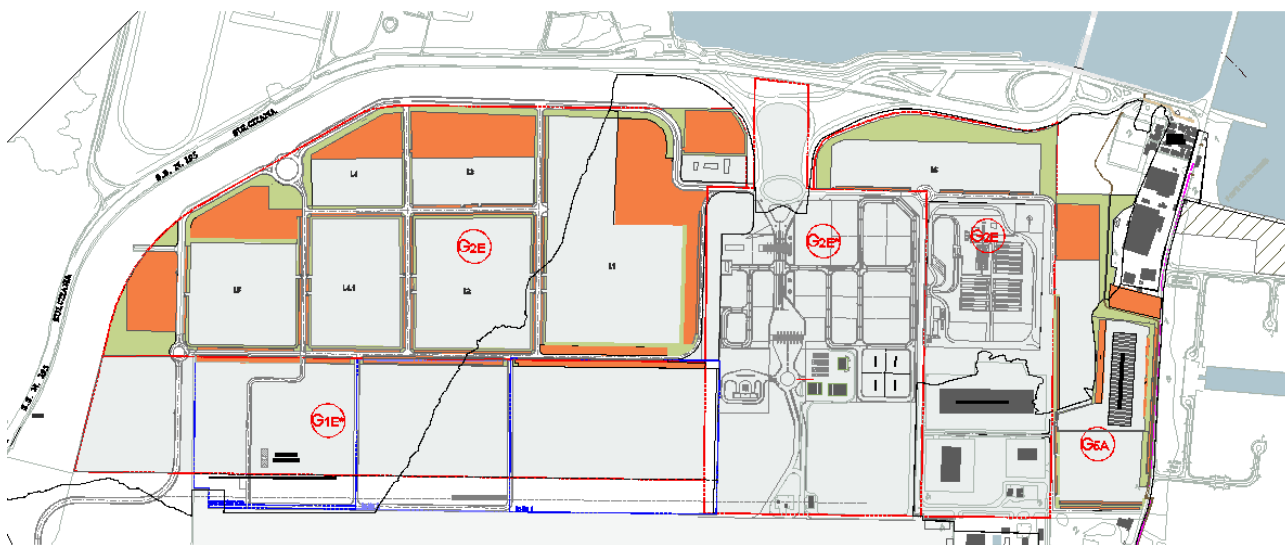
planimetria generale del Piano Attuativo (tavola A6)
